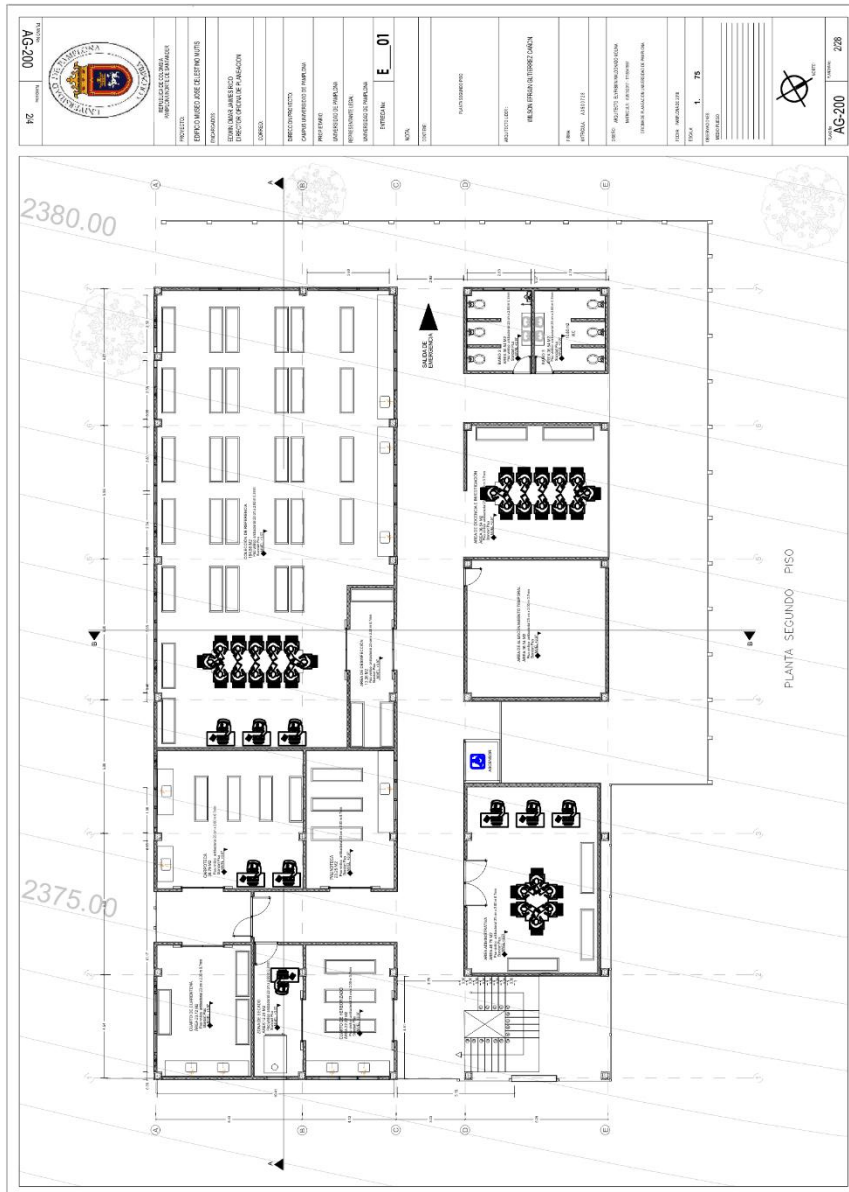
PLANTA ARQUITECTONICA SEGUNDO PISO
